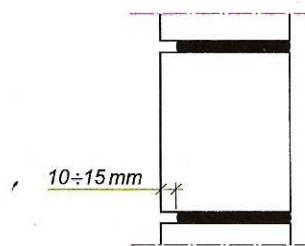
Przykłady wykonywania spoin w ścianach elewacyjnych
